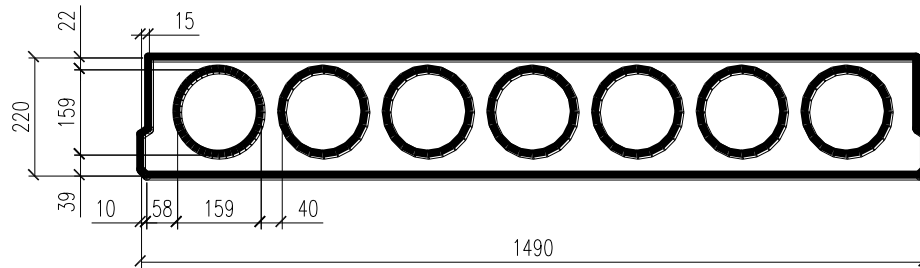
Поперечний переріз багатопустотної плити
